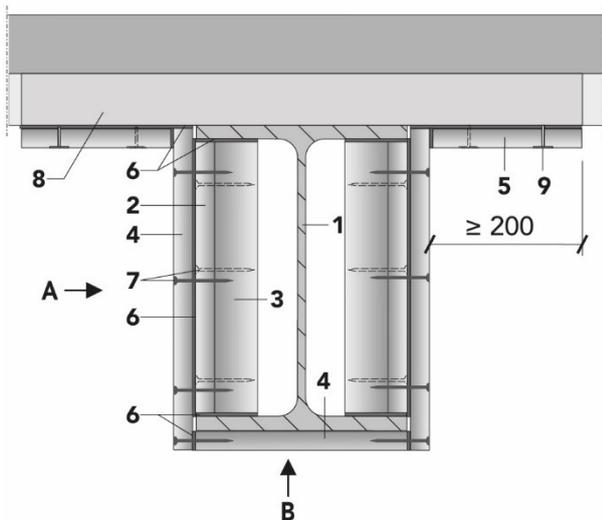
Anschluss an Stahltrapezblechdächer – Variante 1
